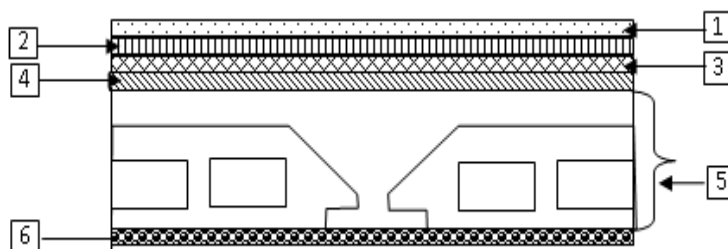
Coupe transversale d'un plancher terrasse inaccessible.
